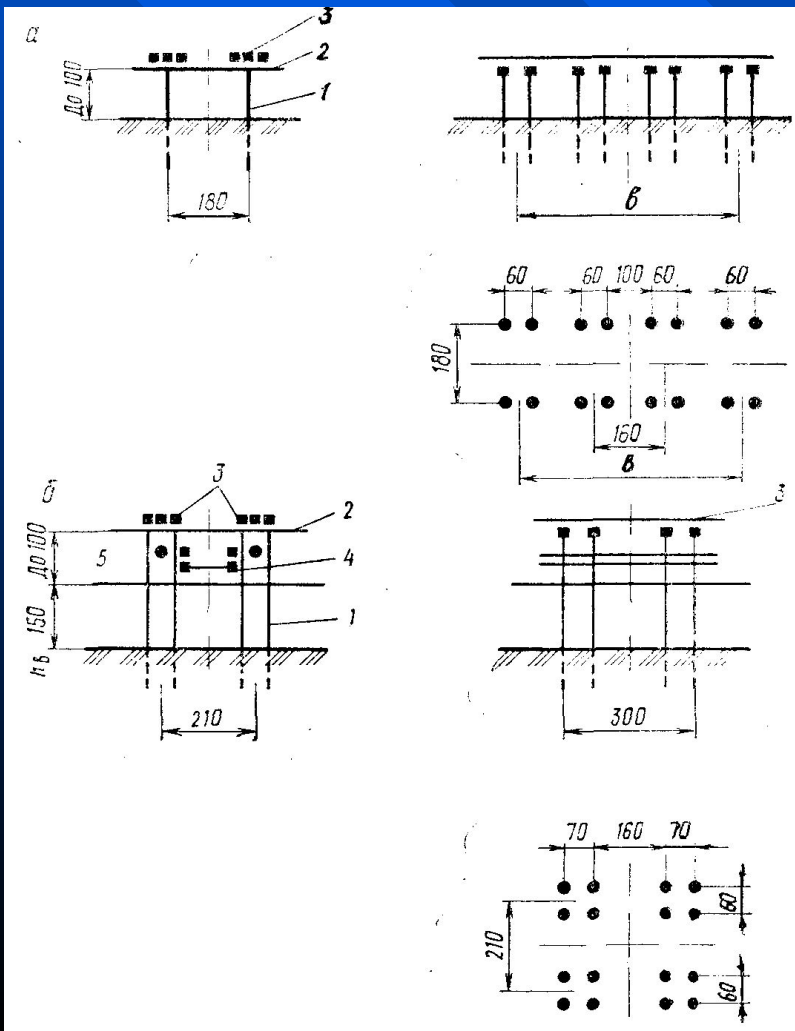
Свайные фундаменты с вертикальными одиночными сваями:
